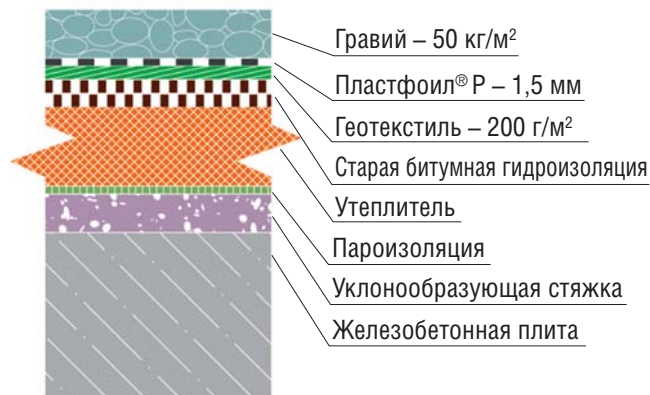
Схема устройства кровли с мембраной ПЛАСТФОИЛ® (PF) по старому покрытию
